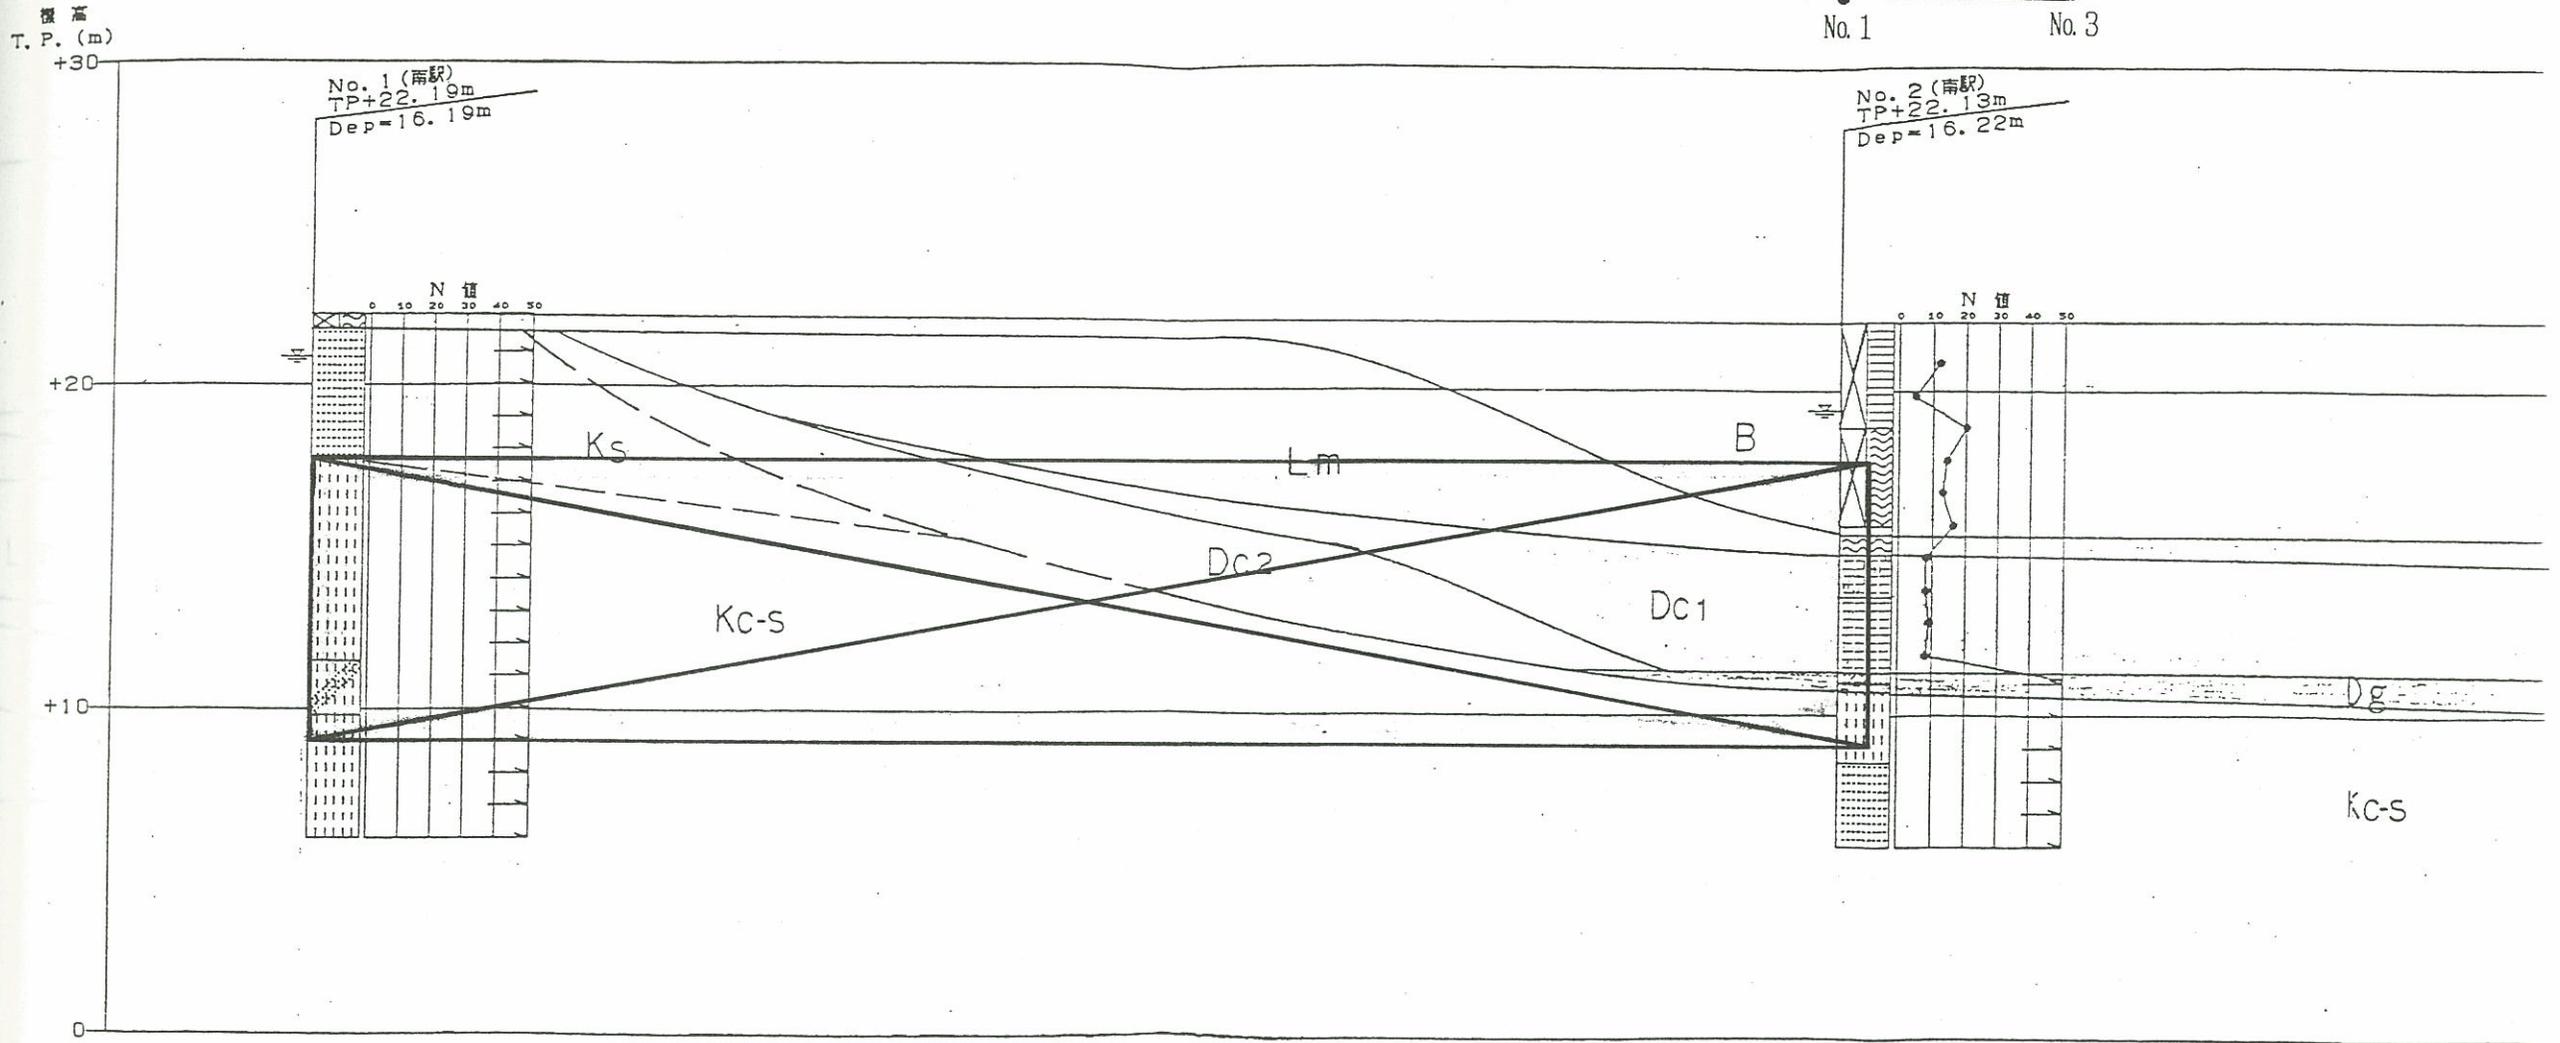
推定土層断面図 縮尺 縦 1/200 横 1/500
